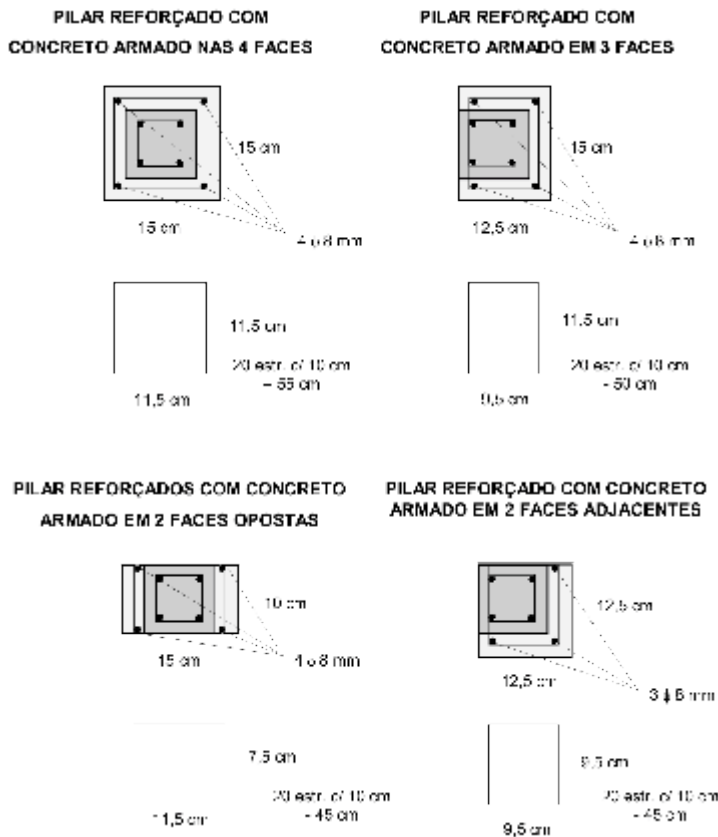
Seções transversais de concreto e armaduras dos pilares reforçados com concreto armado.
